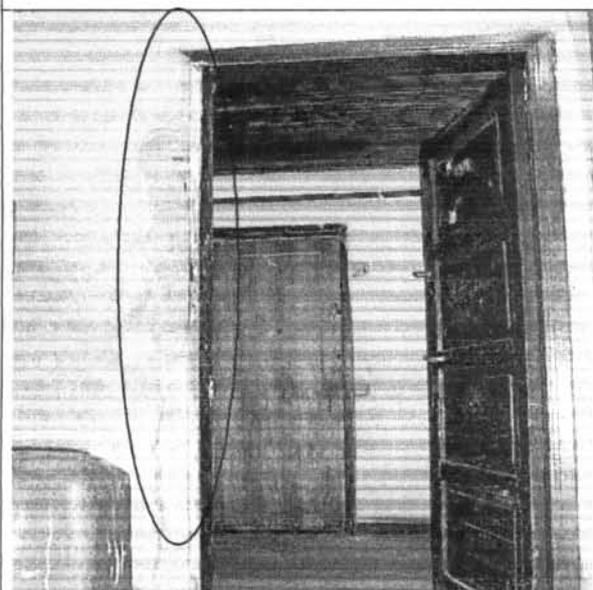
Deterioro progresivo de la edificación y muros fracturados.
